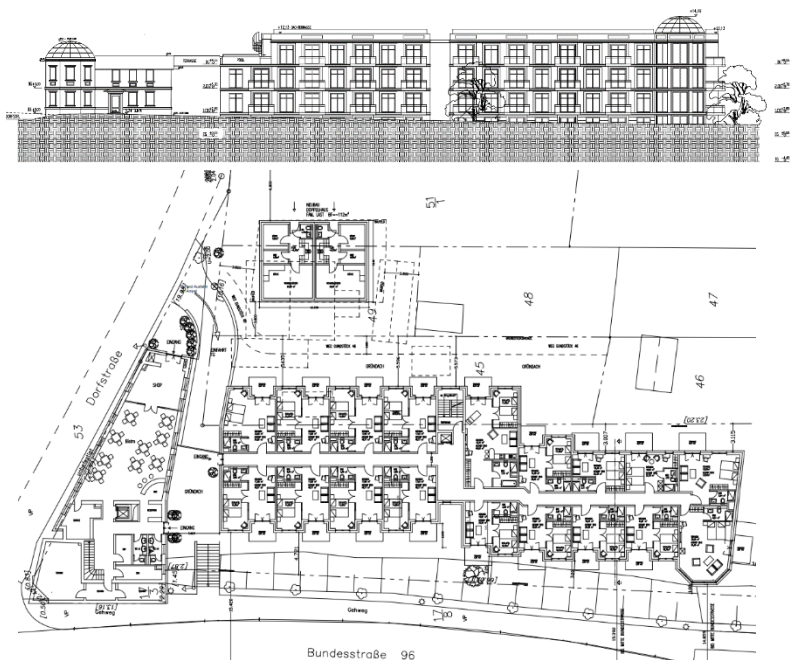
Grundriss EG (unten) und Schnitt (oben), Stand 2023
